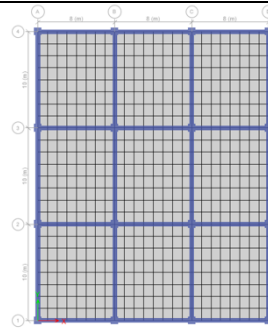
Planta de modelo de 40 niveles orientado en Eje X
